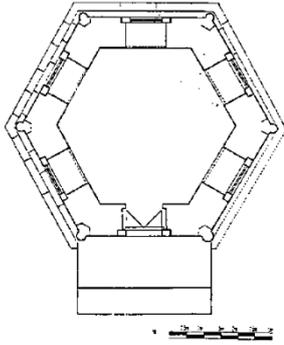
مسقط أفقي لتربة الوالي عزت في أدرنة
